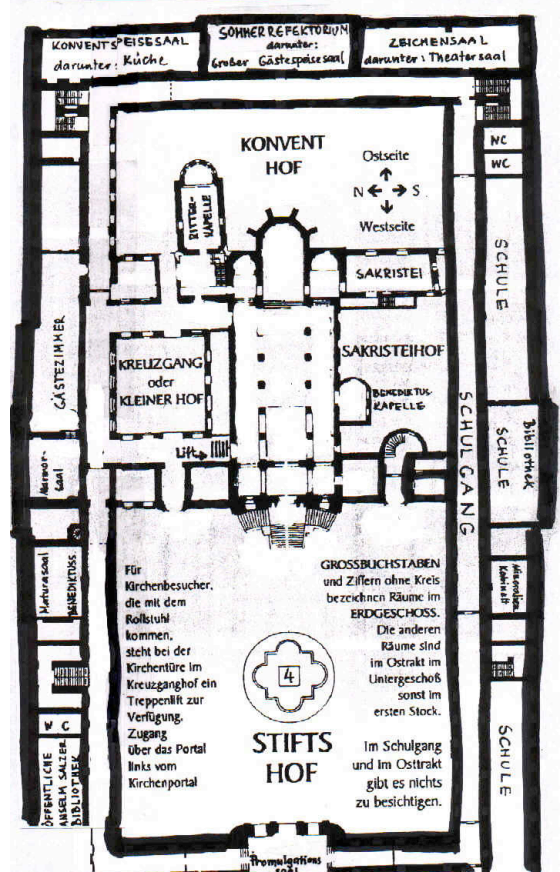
Grundriss: Stift Seitenstetten.
